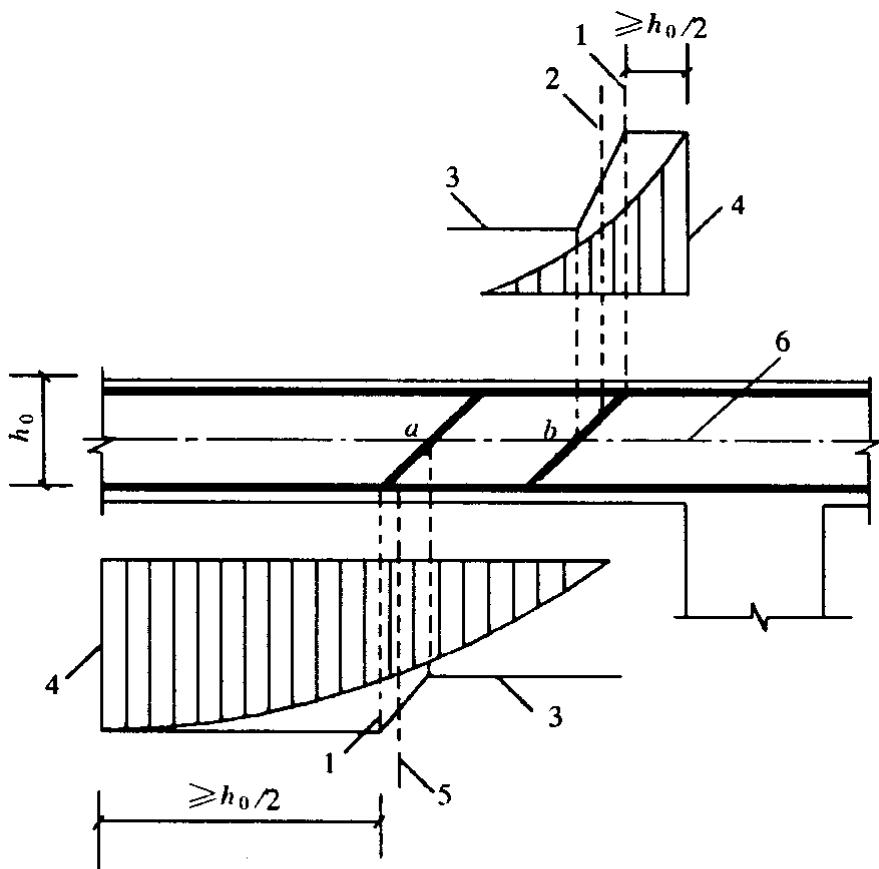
弯起钢筋弯起点与弯矩图的关系
